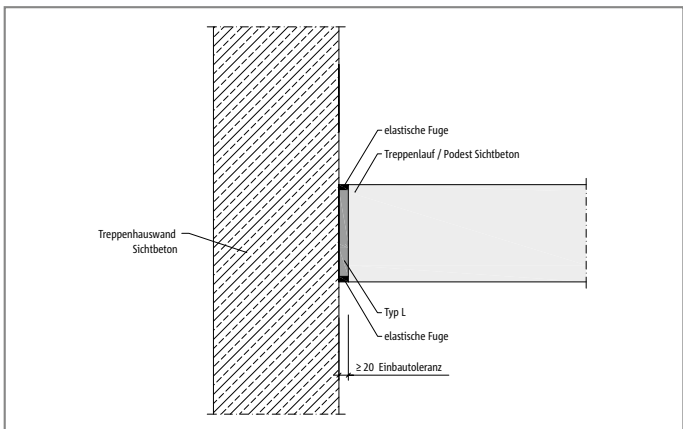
Schöck Tronsole® Typ L: Einbauschnitt Sichtbetontreppe
